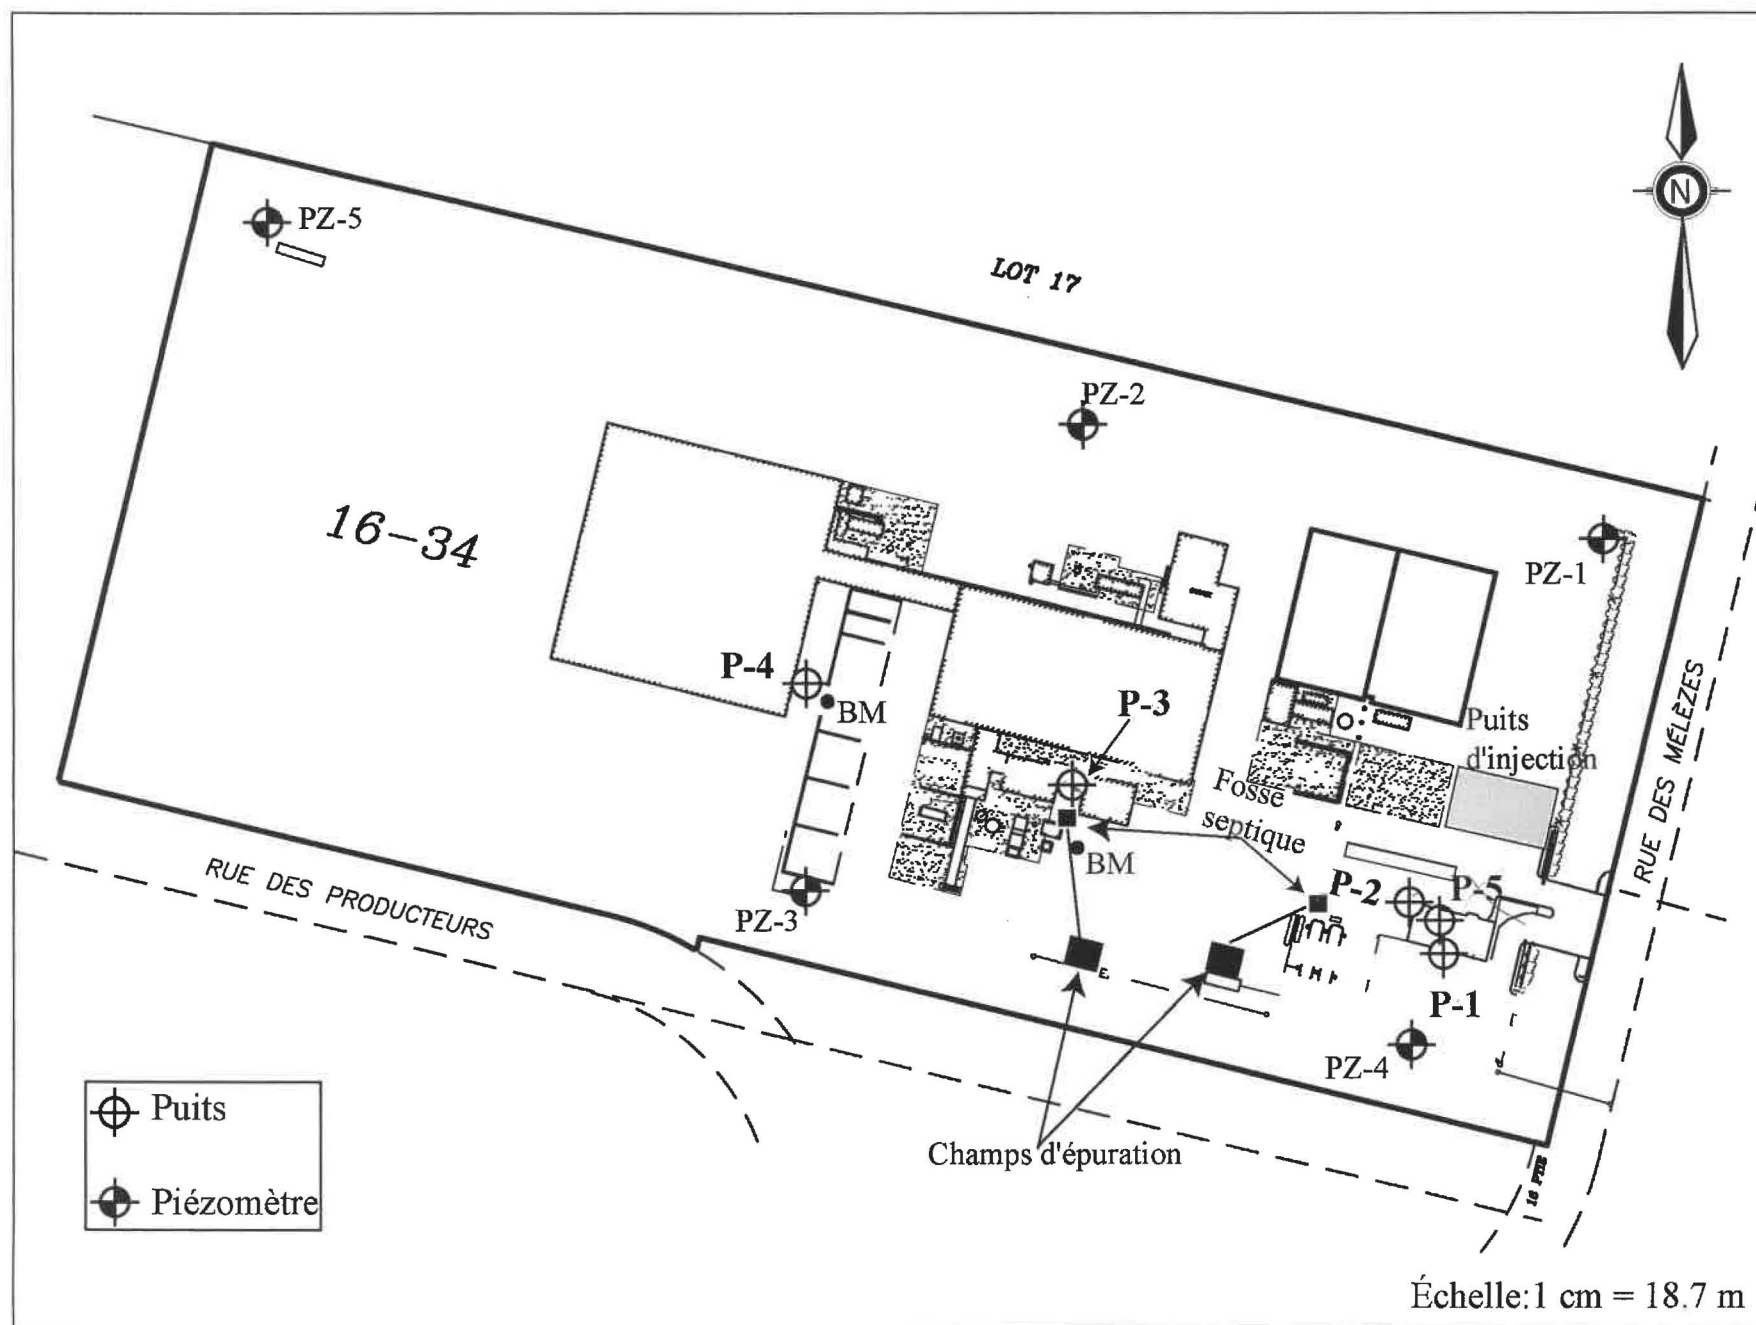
Plan de localisation des puits et piézomètres au site de l'usine.
